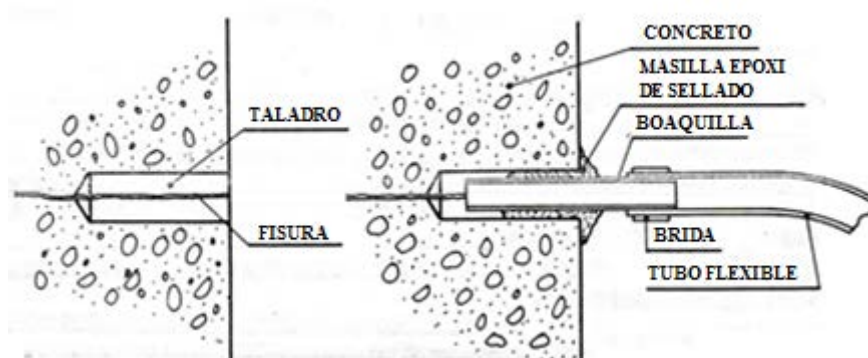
Diagrama de perforación de la grieta (Fernández, 1966)
